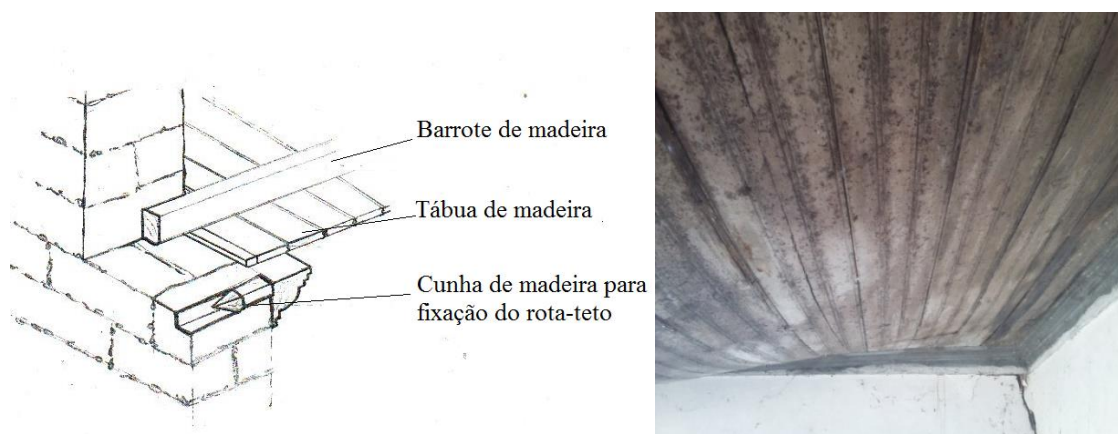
Pormenor construtivo de teto de construção em adobe (Fonte: de autor)
